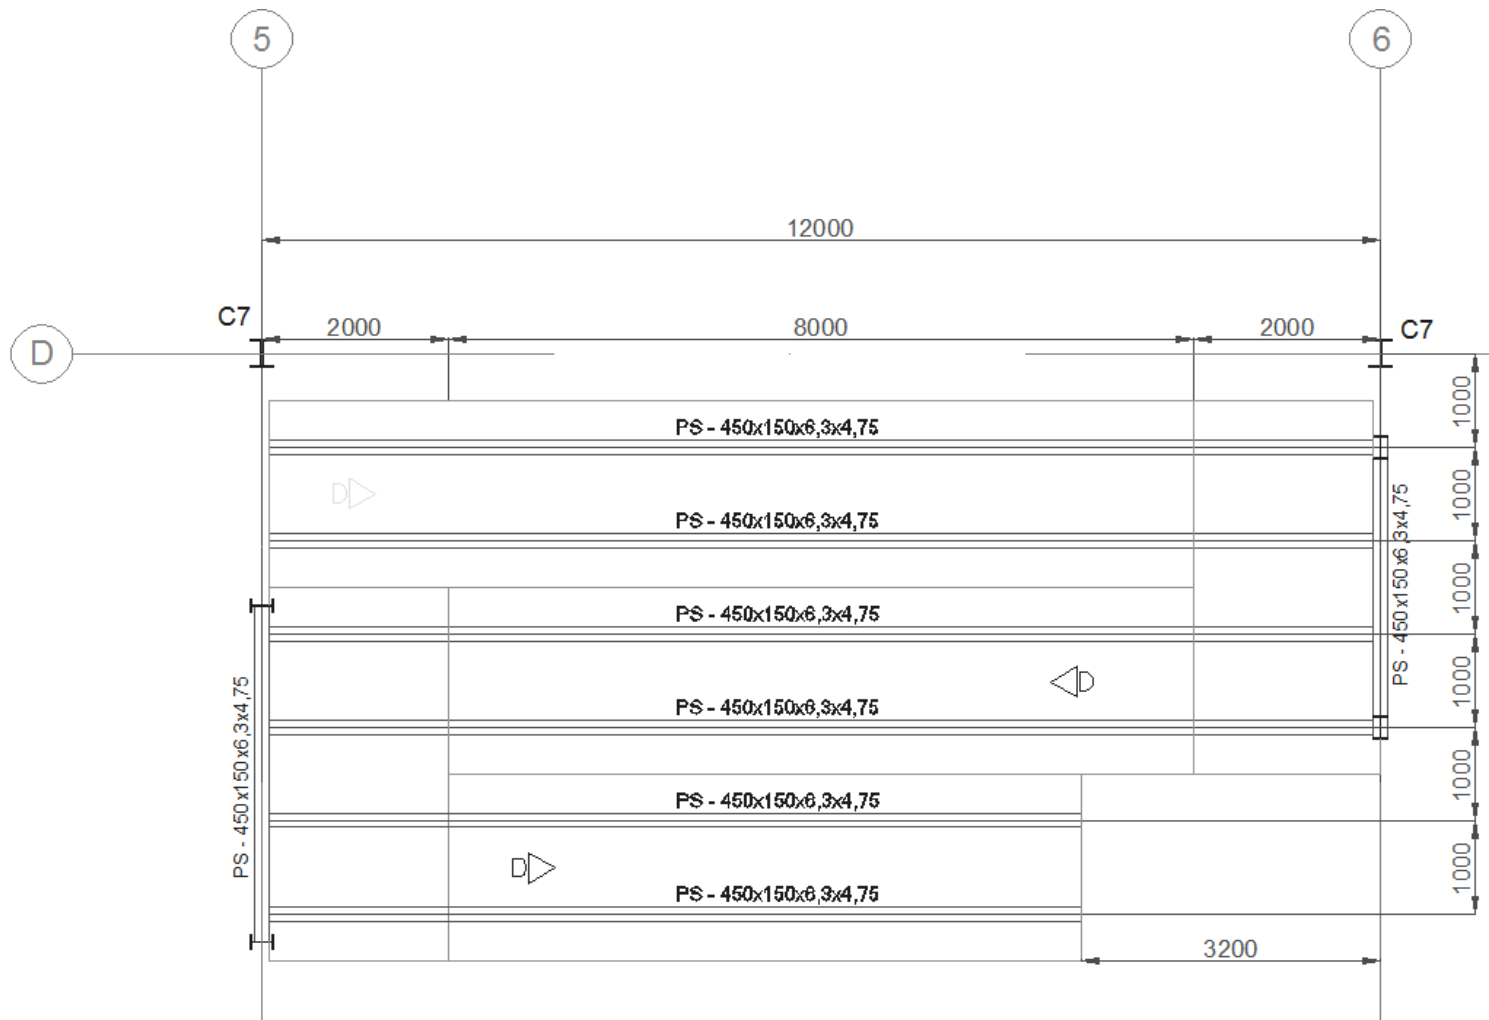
Planta de Elevação Nível + 0 até 2800.
